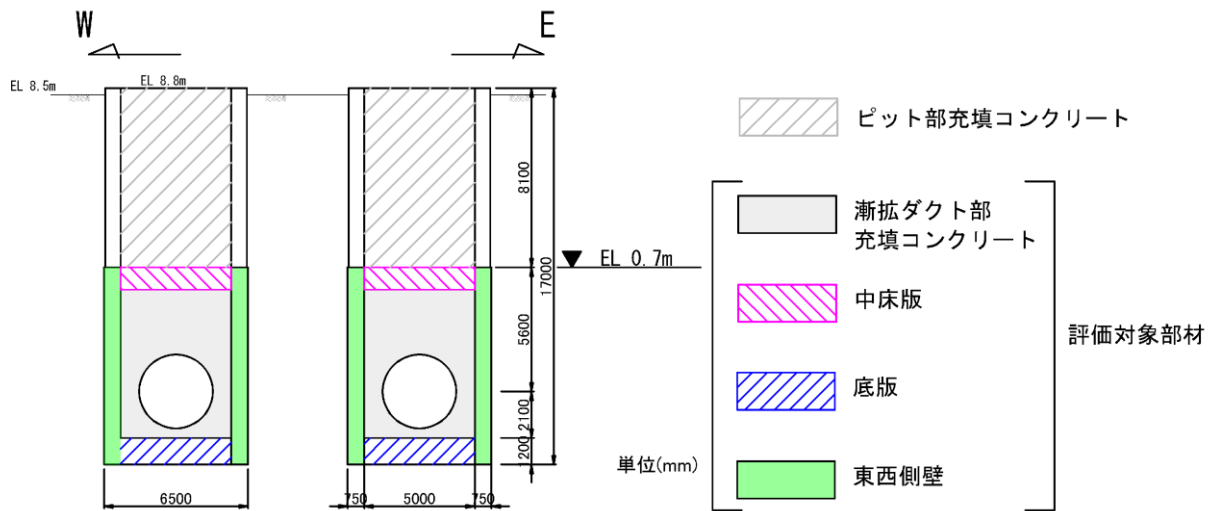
1号機取水槽評価対象断面図 (B-B断面)
